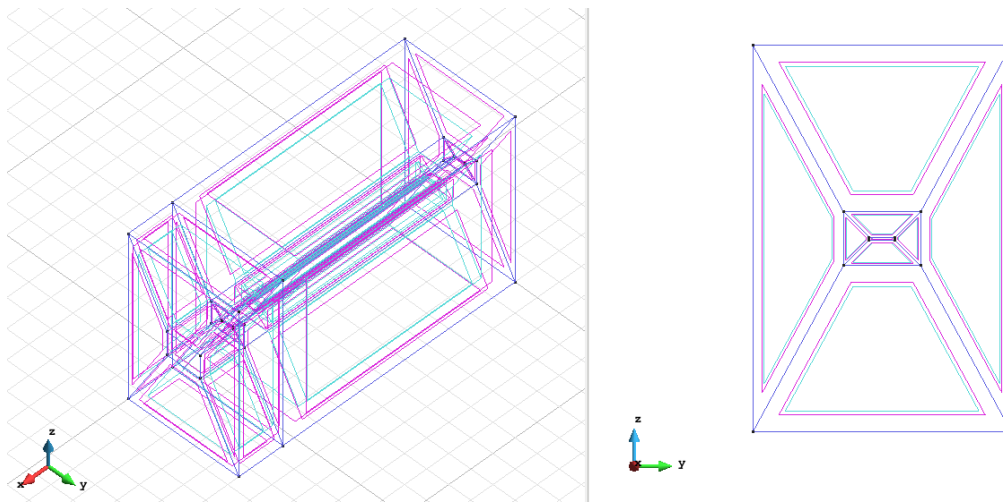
Volumen generado total, SOIL, INTERFASE y REFUERZO, medidas del volumen SOIL, A) Isométrico, B) Plano ZY
